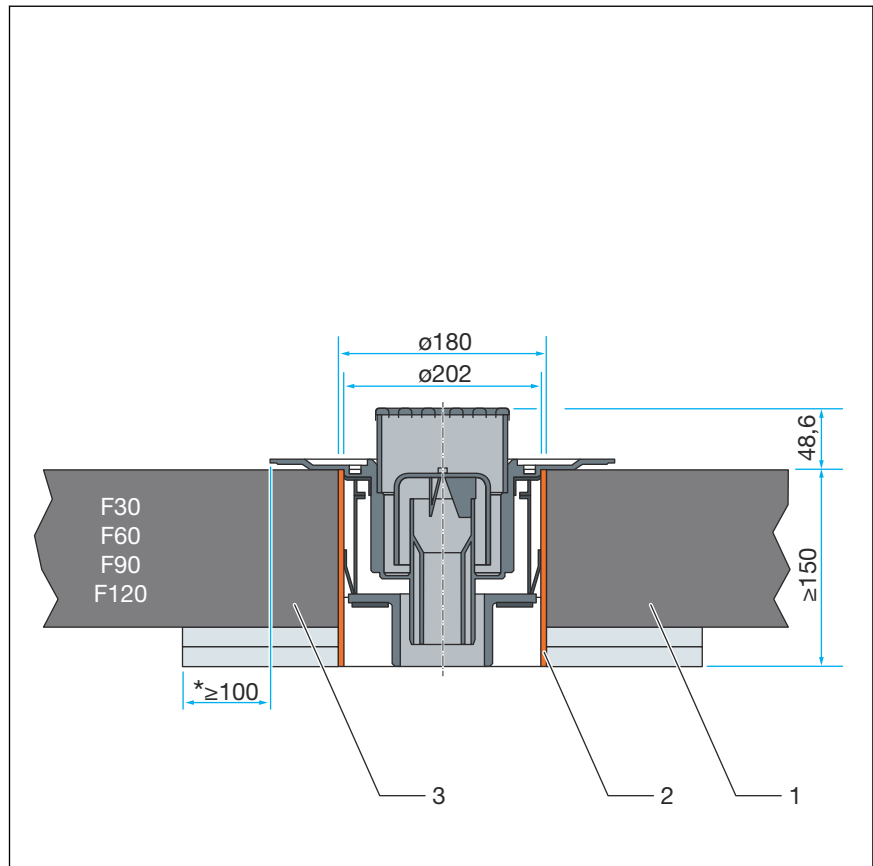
Beispiel: Bodenablauf in einer Kernbohrung mit Bodenaufbauplatten unter der Decke
